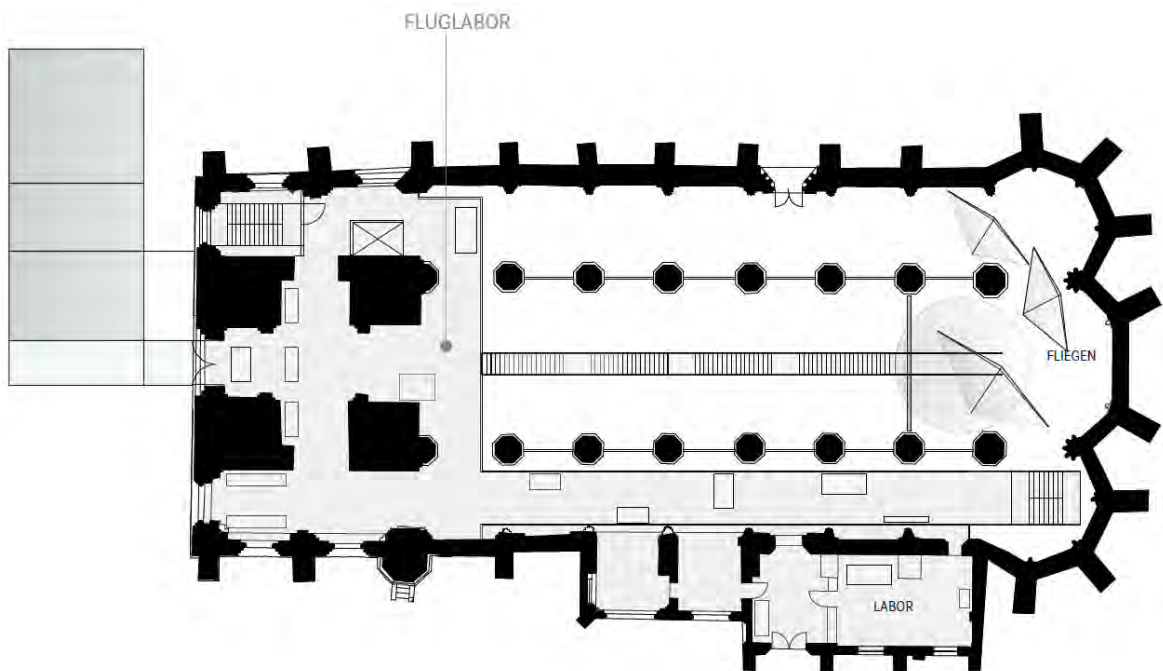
Grundriss der Ausstellung im Galleriegeschoss
